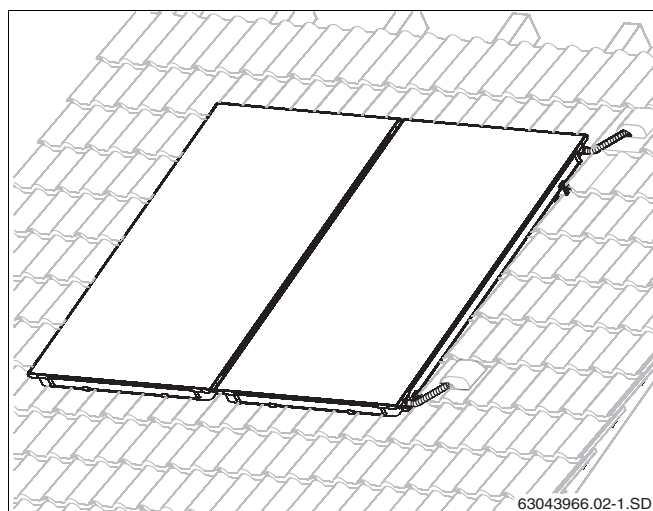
Imagem geral do conjunto de colectores, instalação sobre o telhado
